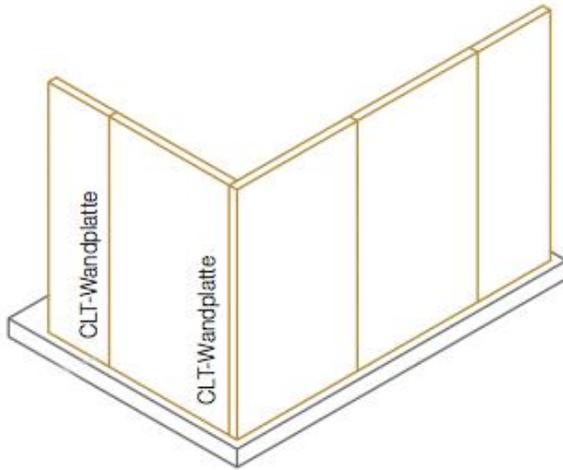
Grundlegende Konstruktionsregeln – Variante II¹⁷⁵
